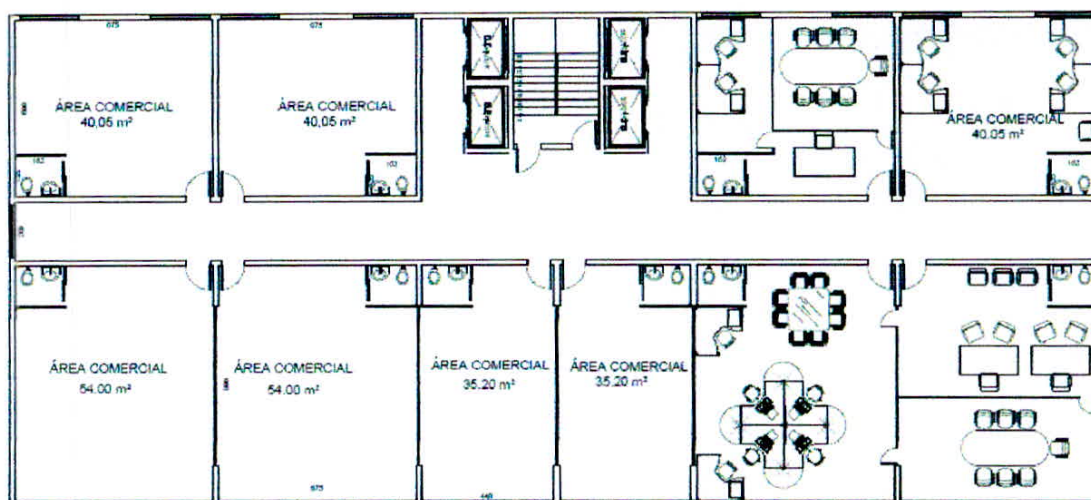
Projeto arquitetônico do pavimento tipo, projeto proposto
